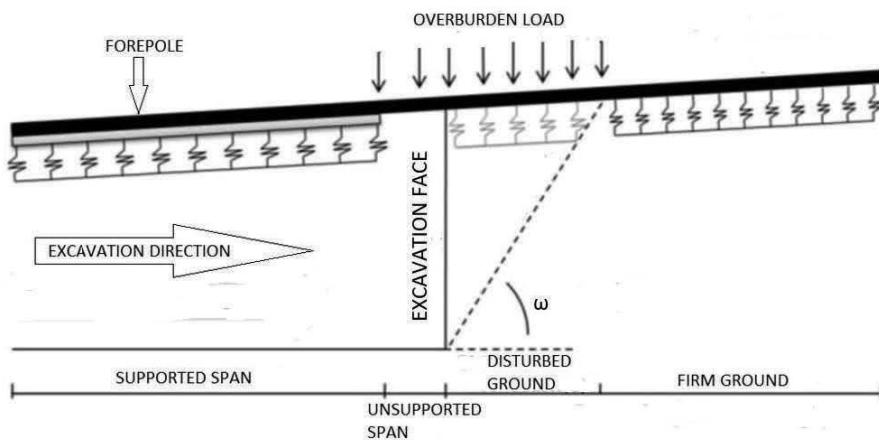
Lasten på spilingelementen ersatta med två belastade balkar (Ranjbarnia m.fl., 2018).
